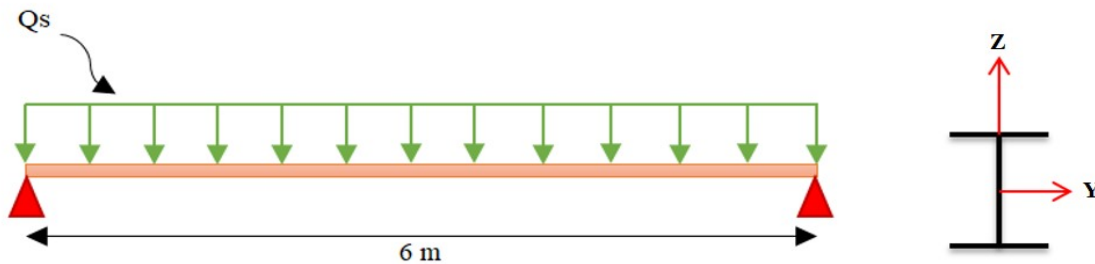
Schéma statique de la poutre secondaire sous chargement.
